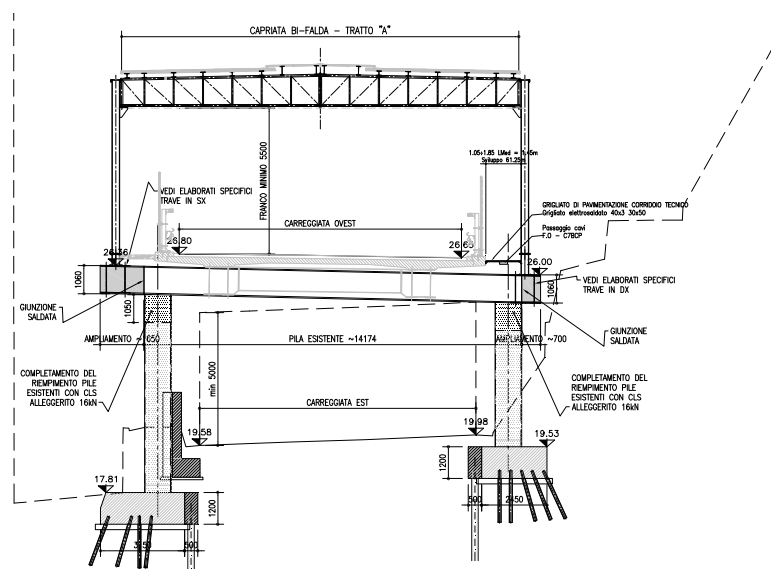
Sezione trasversale in corrispondenza della pila 6
